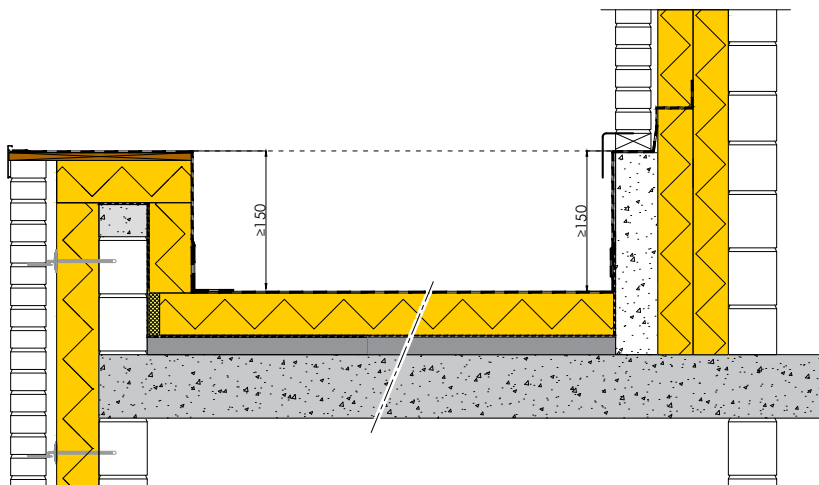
Hauteur de mur acrotère avec une maçonnerie verticale
